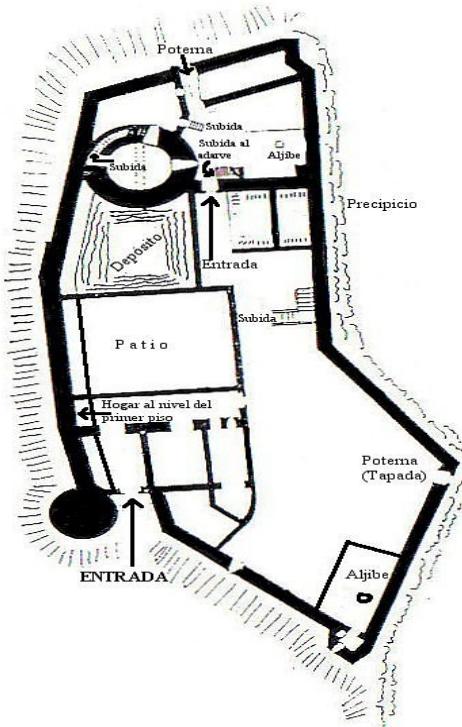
Planta del castillo. Fuente: iesmunoztorrero.juntaextremadura.net
